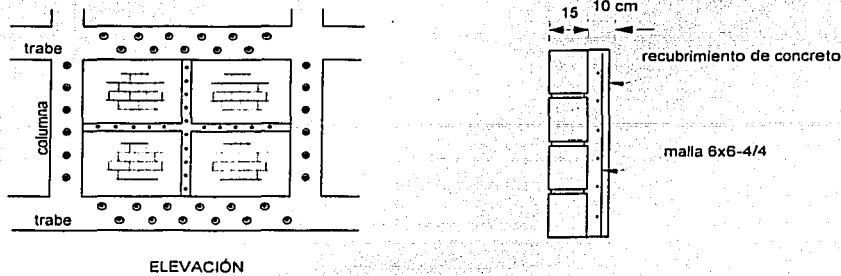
Detalles del refuerzo del proyecto no. 3
